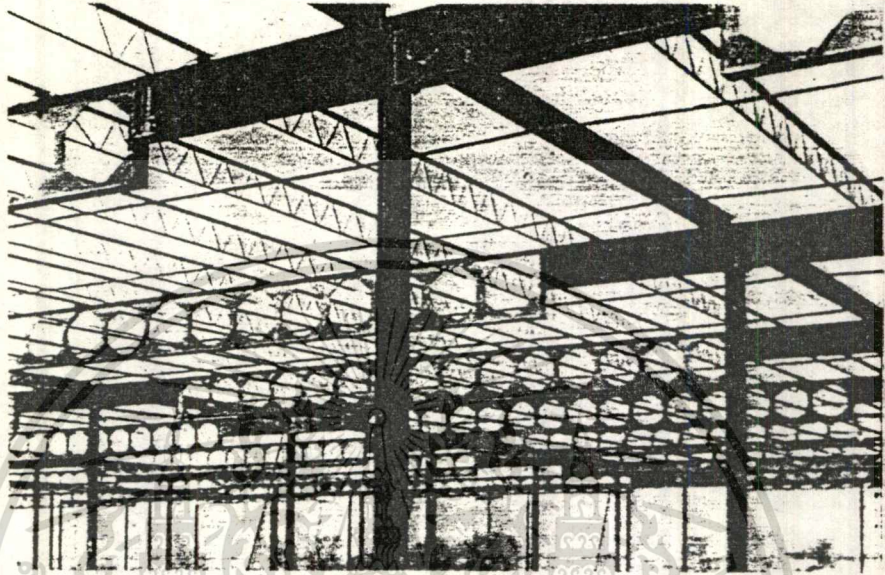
แสดงการวิบัติที่เกิดขึ้นใกล้ ๆ กับ expansion joint พื้นที่หลังคาประมาณ 12,000 ตารางฟุตได้พังลงมาระหว่างที่มีพายุฝนซึ่งเป็นเหตุให้เกิดการสะสมของน้ำบนหลังคา
